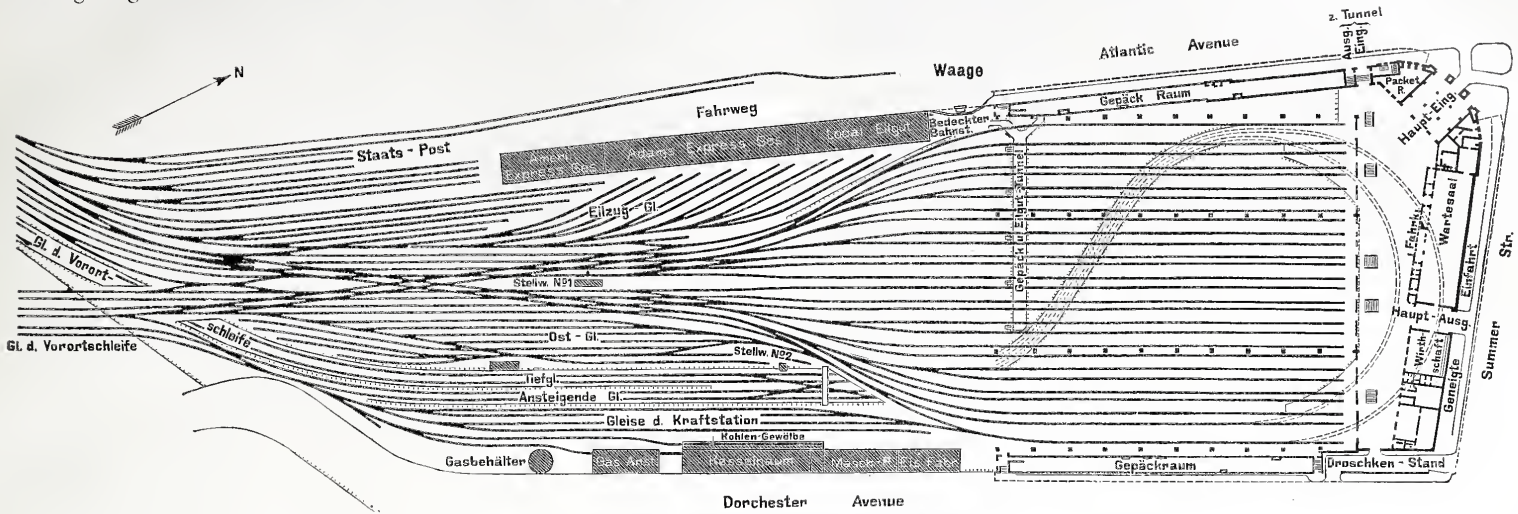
Grundriss des Südunionbahnhofs.
